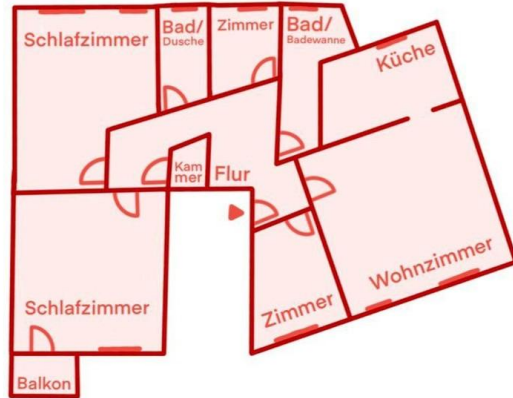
Grundriss Attilagarten 1, EG
